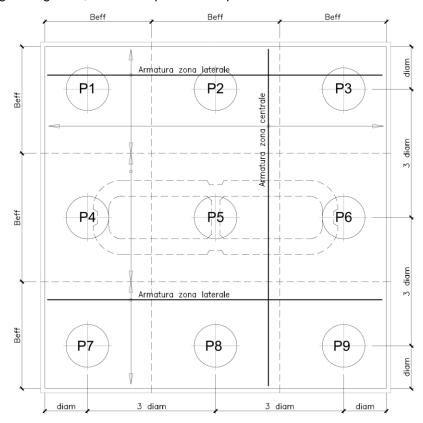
Plinto di fondazione – Armatura longitudinale inferiore e superiore
